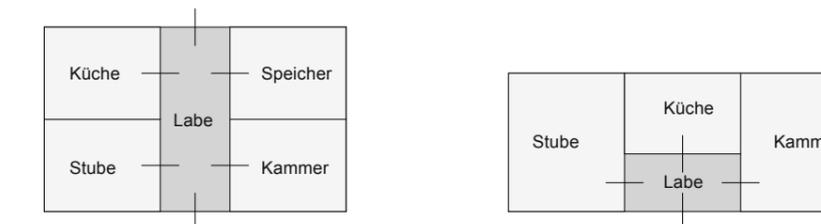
Wohnhausgrundriss mit durchgehender und abgeriegelter Labe.
